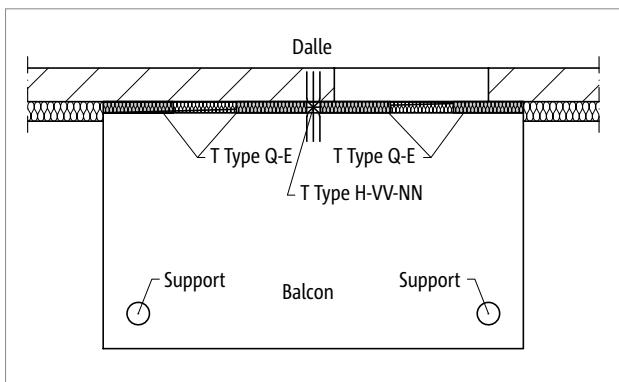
Schöck Isokorb® T Type H : Balcon avec appuis
